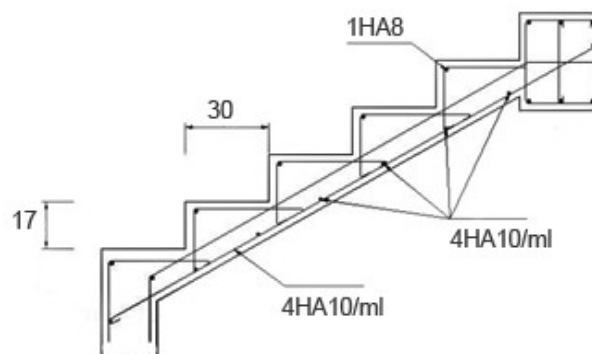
Ferrailage de l'escalier du rez-de-chaussée
